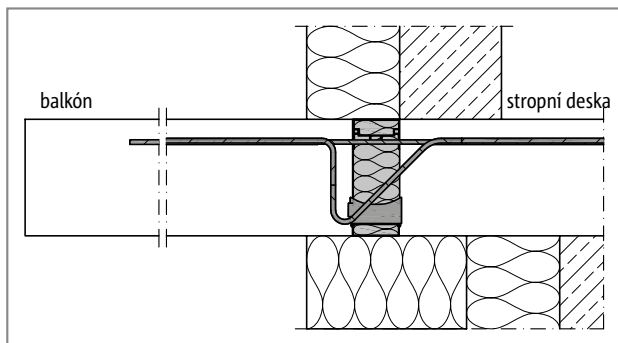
Schöck Isokorb® T typ KL a QL-VV: Balkón uloženy ze dvou stran
